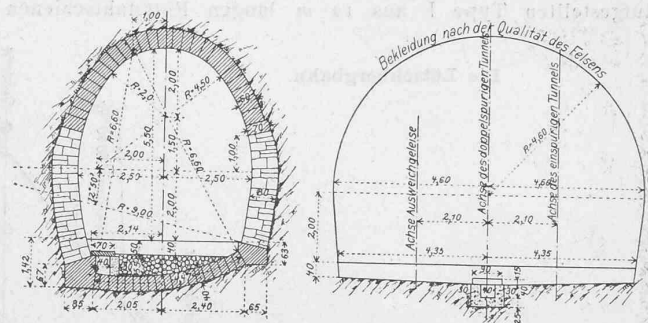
u. 7. Tunnelprofile zu Projekt I. — 1:200.
